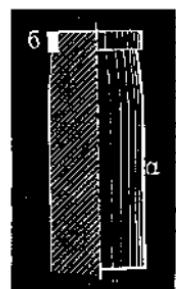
Кольцо-бугель, насаженное на сваю, въсомъ 6—15 фунтовъ: а—свая; б—бугель.
